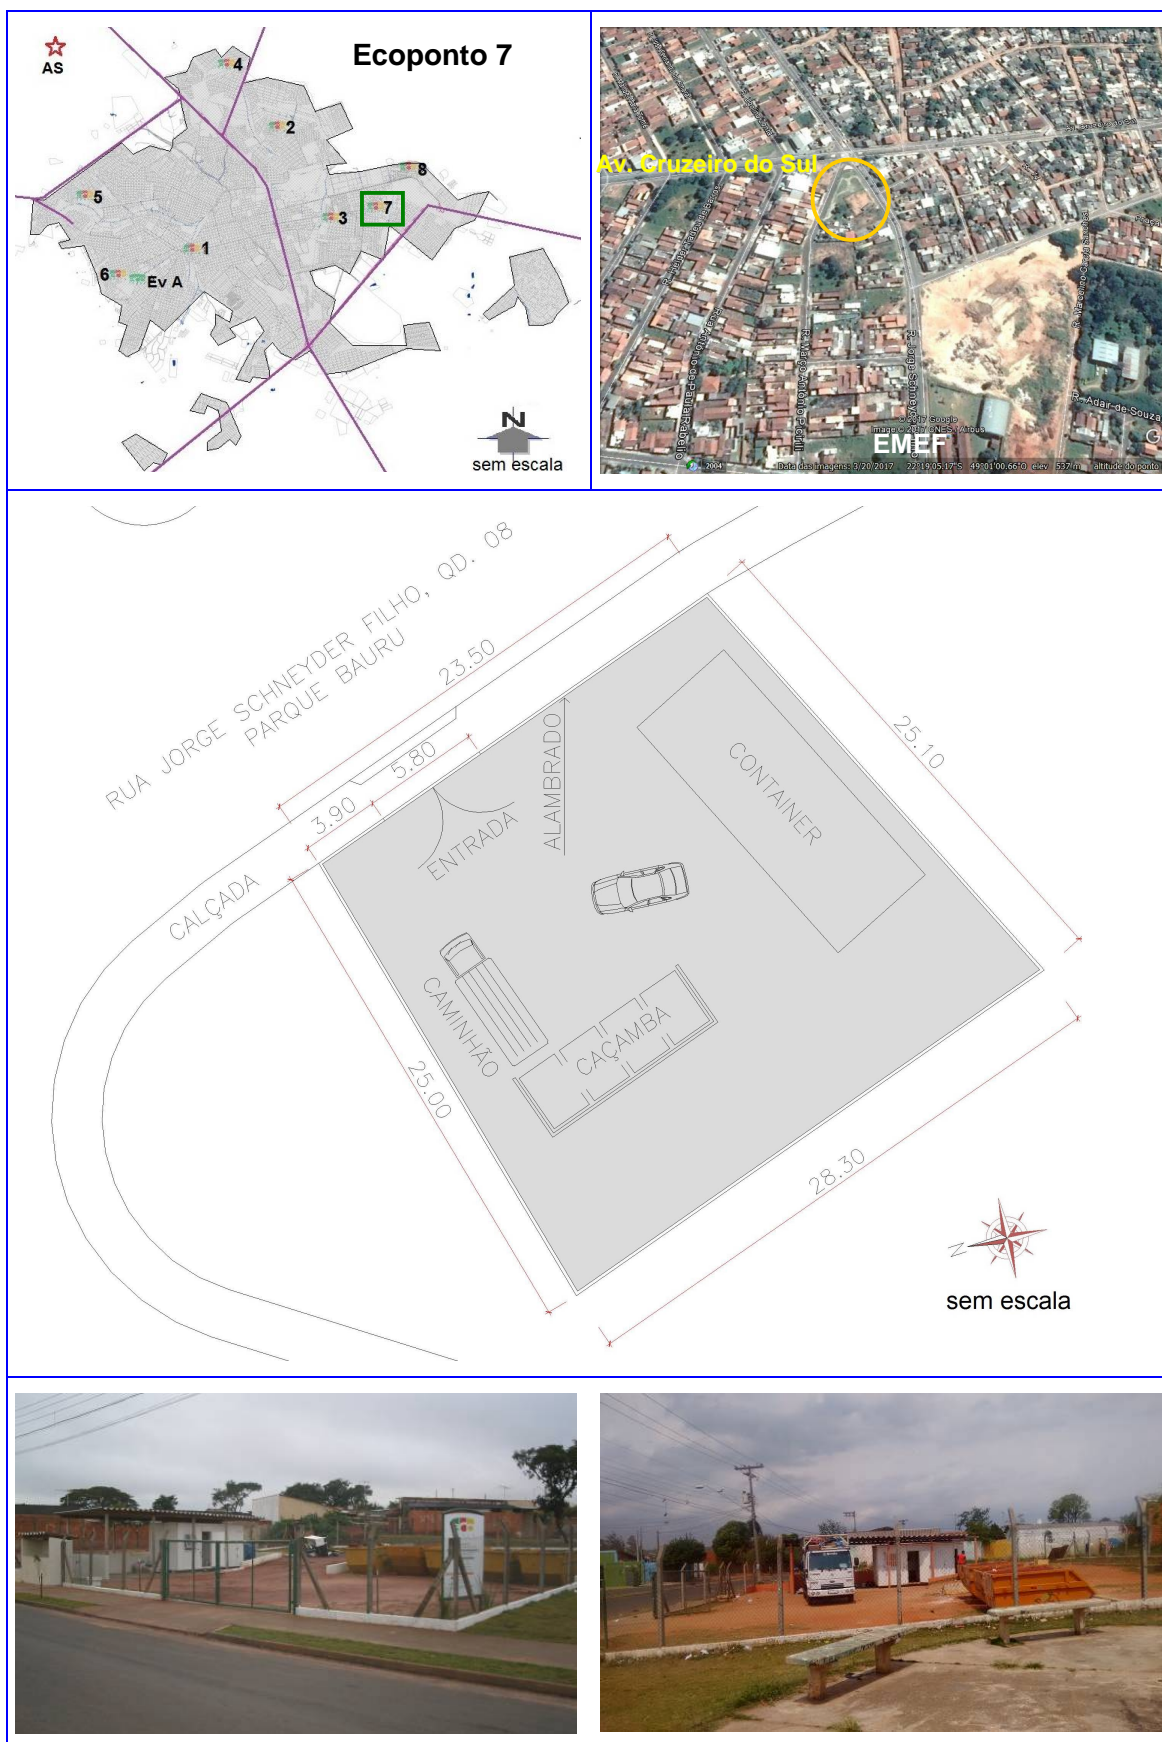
Localização, planta (sem escala) e imagens do Ecoporto 7
